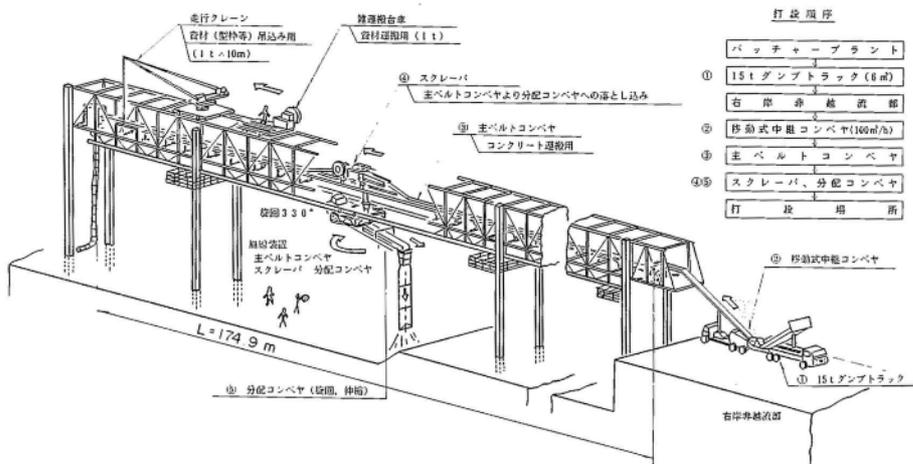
BCP 工法による堤頂部コンクリート打設要領図 (竜門ダム)
